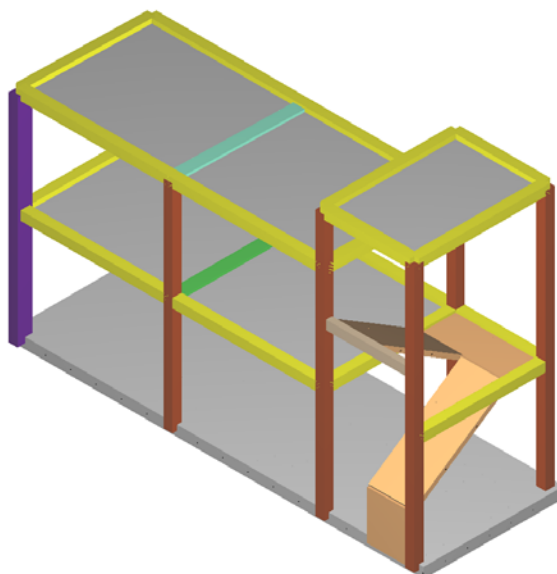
Modello agli elementi finiti – Strutture in elevazione e di fondazione
